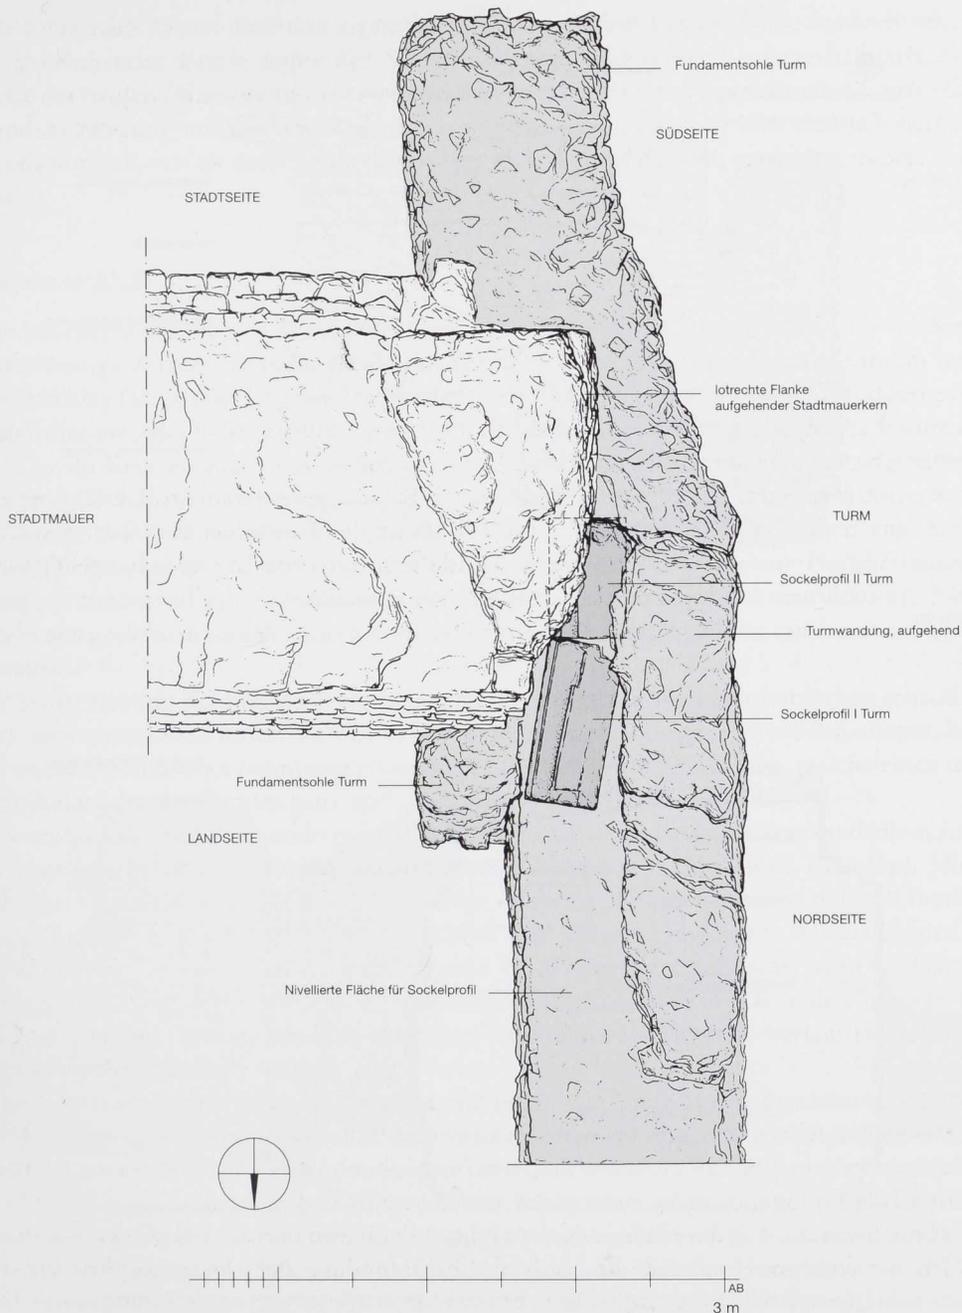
Fundamentreste des östlichen Torturmes. Grundriß des erhaltenen Baubestandes. – M = 1:50.
